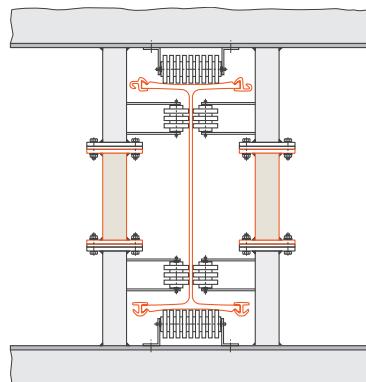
Detalle del sistema de guiado de los HZ-M.
